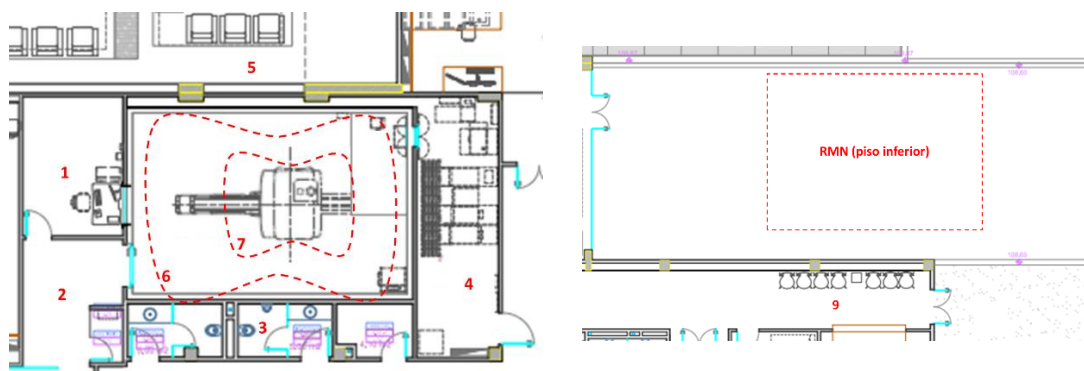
A imagem da esquerda está detalhada a planta do piso de instalação do equipamento GE. Na imagem da direita está detalhada a planta do piso superior à instalação do equipamento GE
